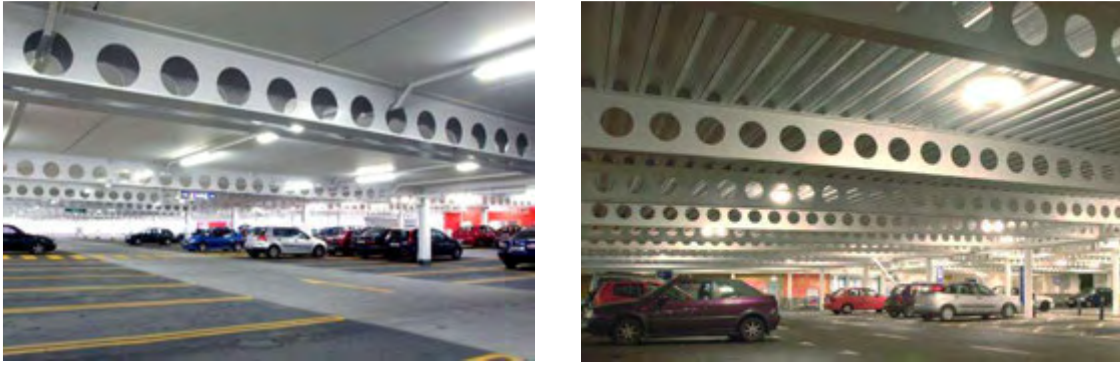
Vigas celulares aplicadas em sistemas de piso
